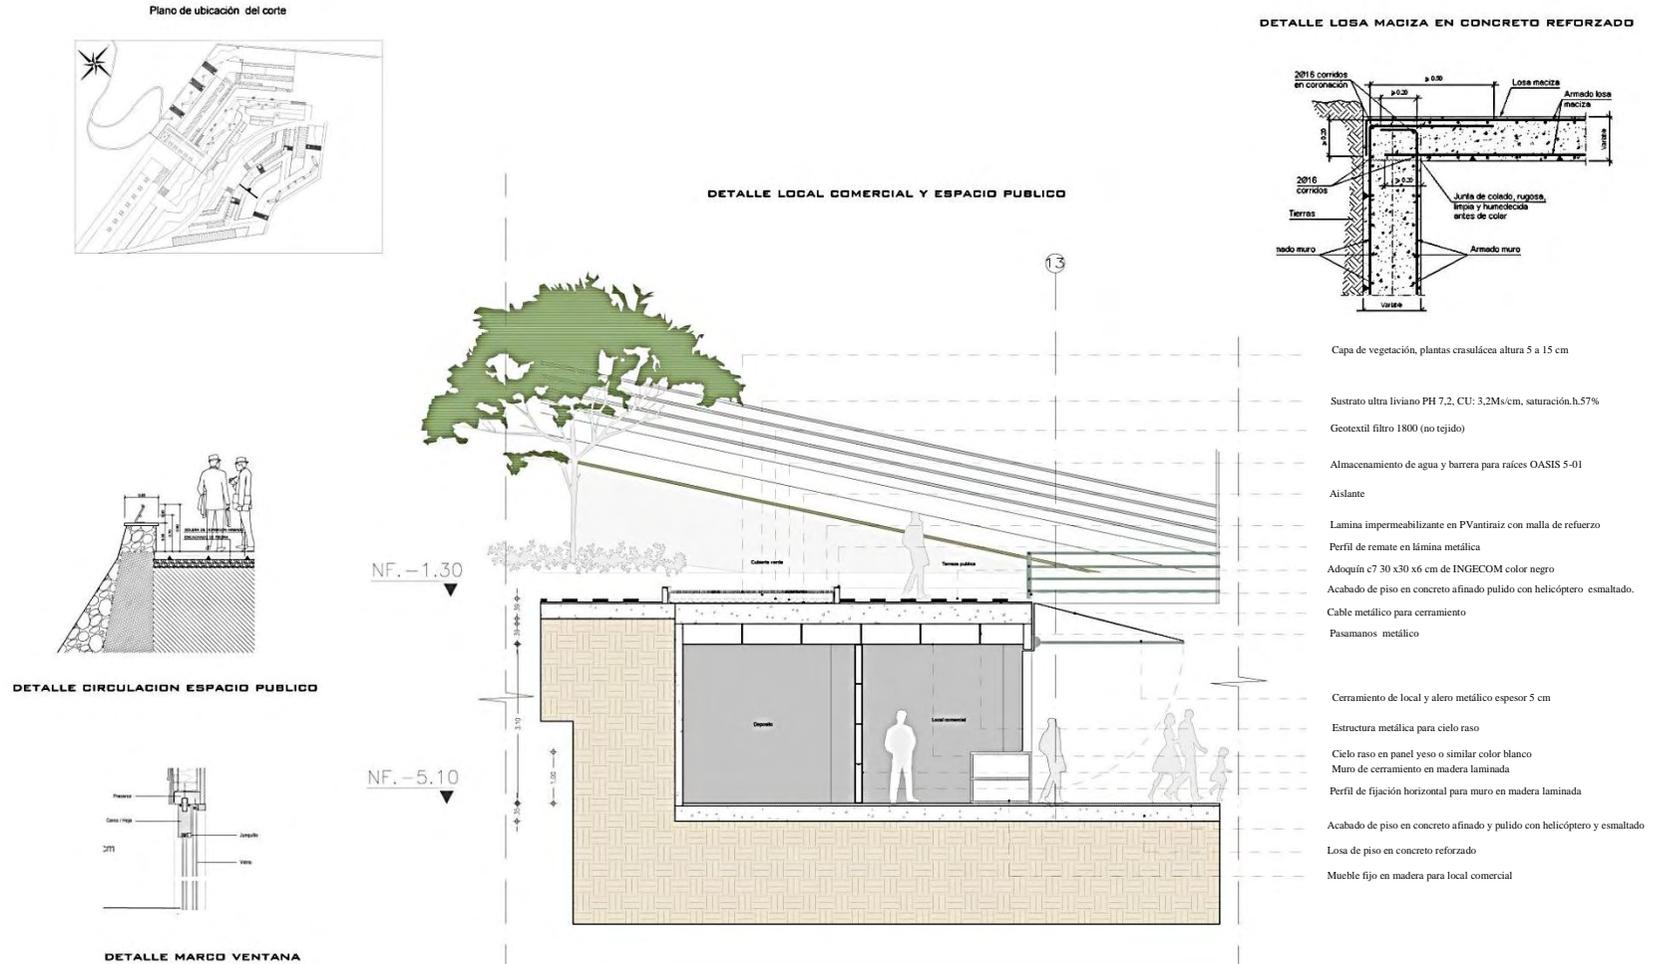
//imagen plano detalles constructivos centro gastronómico: elaboración propia
